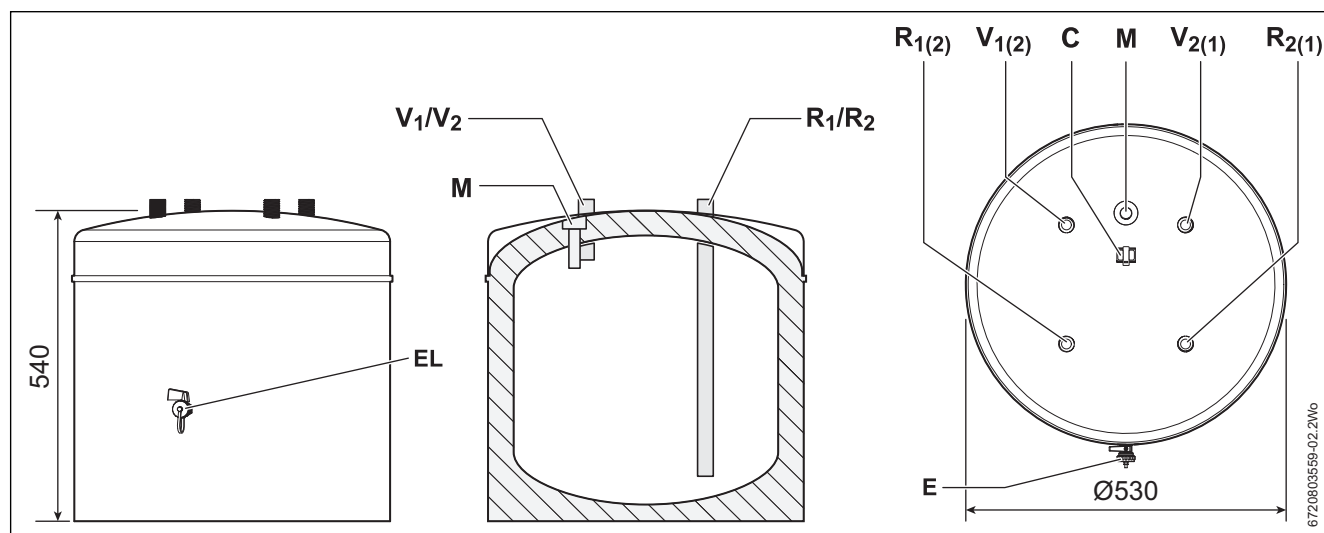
Dimensiuni și racorduri (dimensiuni în mm)
